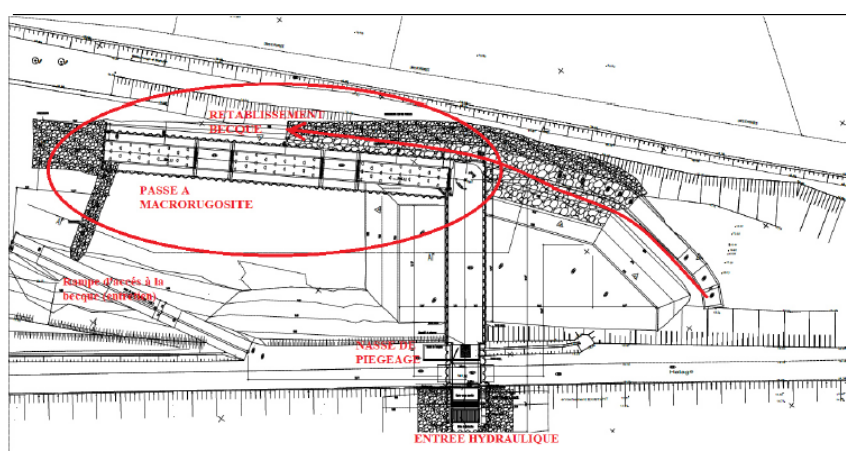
Vue en plan de la passe à poisson amont (Source : dossier)
